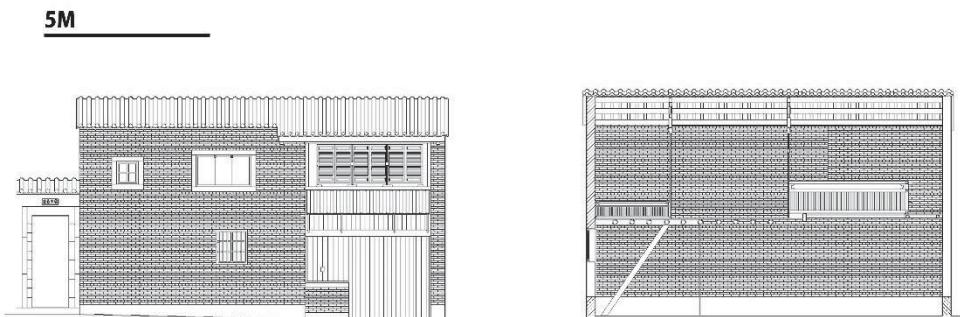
叢桂西街 20 番の立面と断面図（資料提供：中山大学）
